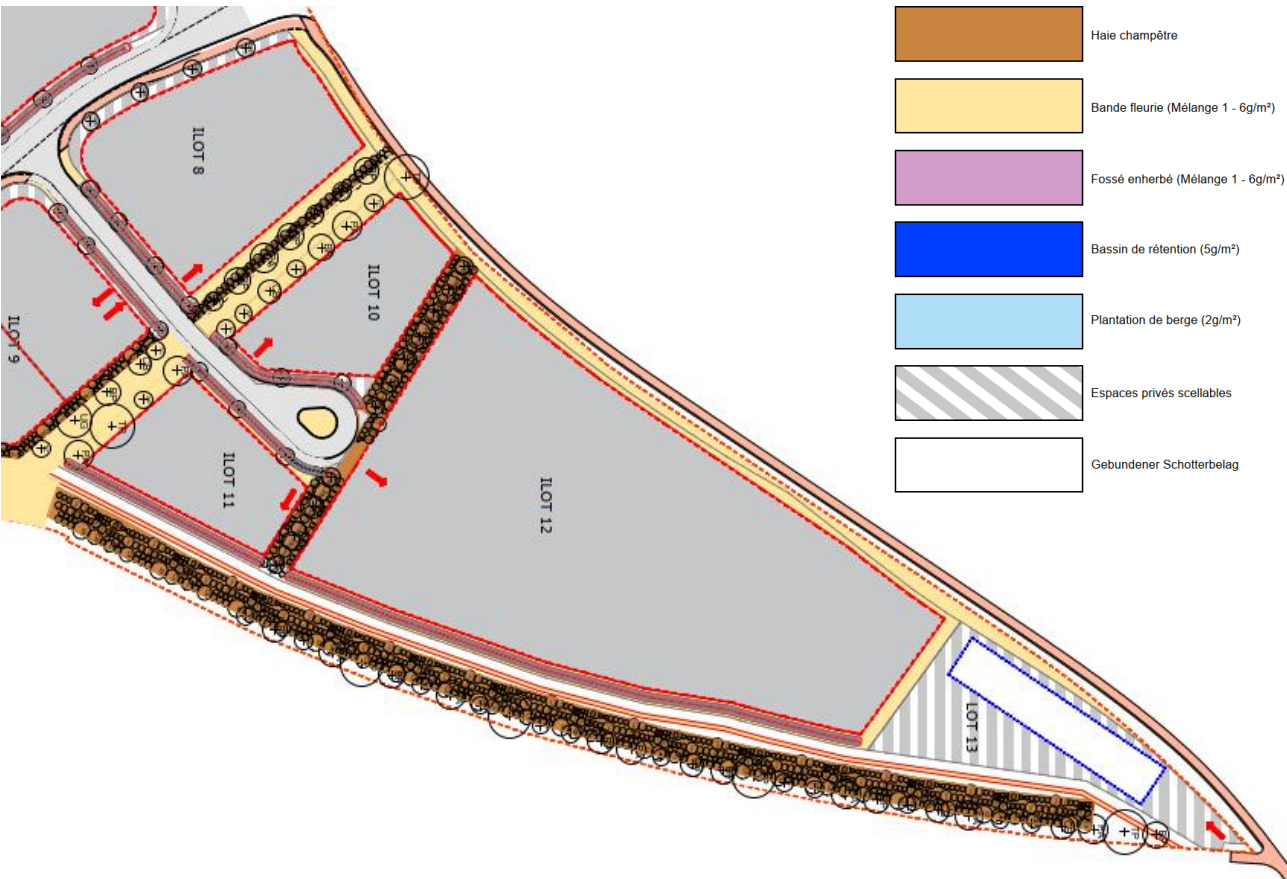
Ausschnitt Nordost aus dem Plan de Plantation (Quelle: Papaya Sàrl 2025). Darstellung nicht genordet. Größere Darstellung in Anhang 06.
